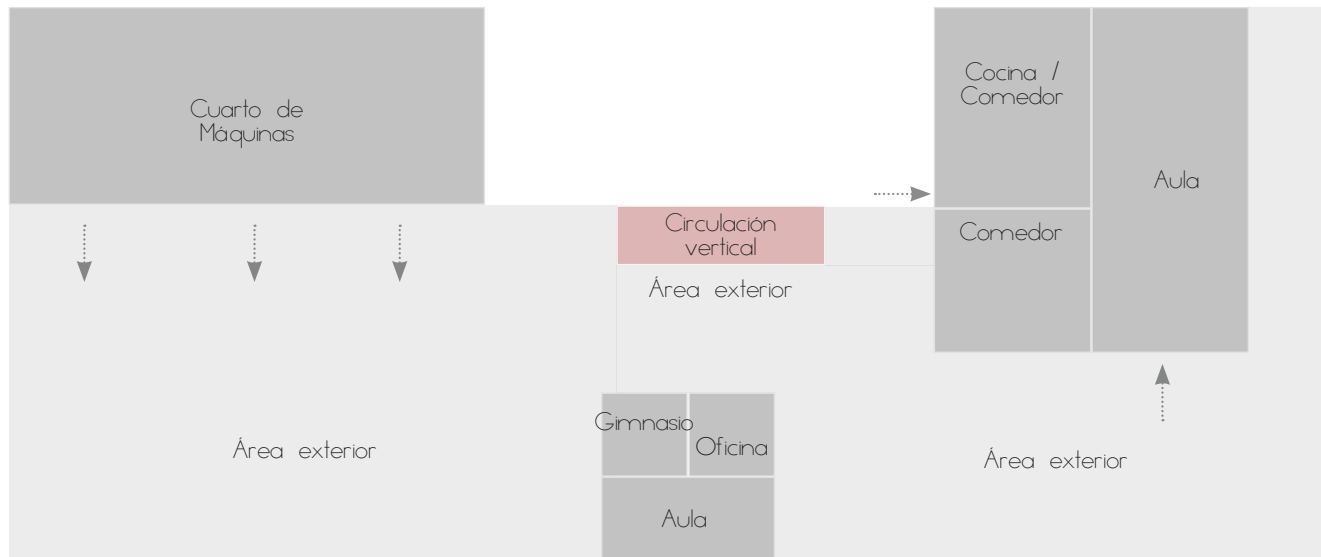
Zonificación planta baja estación N°9. (Autoras, 2019)
